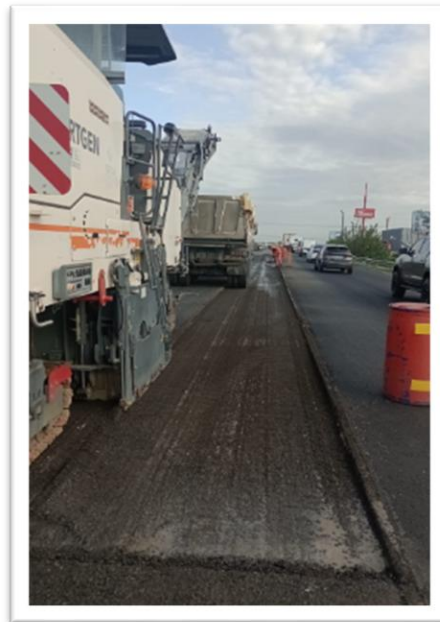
Fresado de pavimento con fresadora de 1 metro de ancho de tambor
